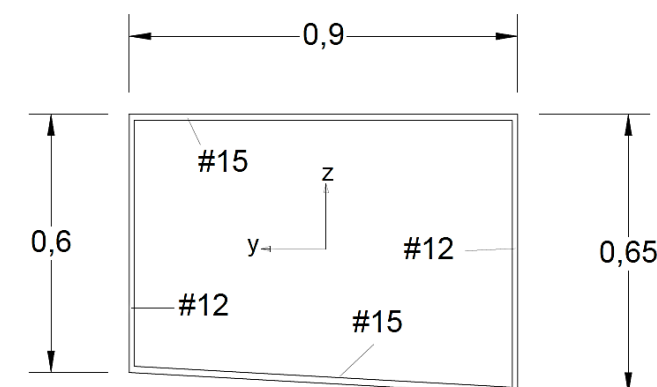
Sección transversales vigas longitudinales. Elaboración propia con AutoCAD
